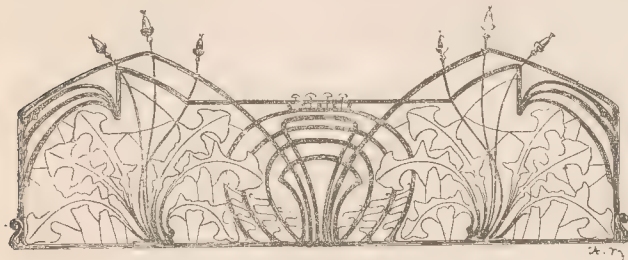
Milano: Parapetto nel Palazzo delle Assicurazioni Gen. di Venezia. (Alessandro Mazzucotelli).
